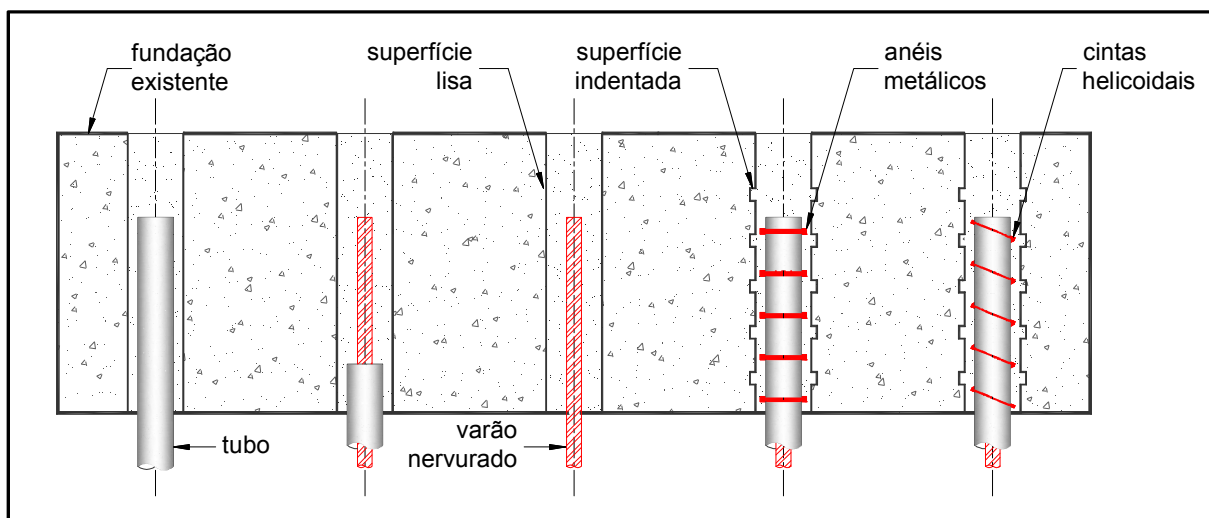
Ligações tipo micro-estaca seladas em fundações de concreto armado existentes
